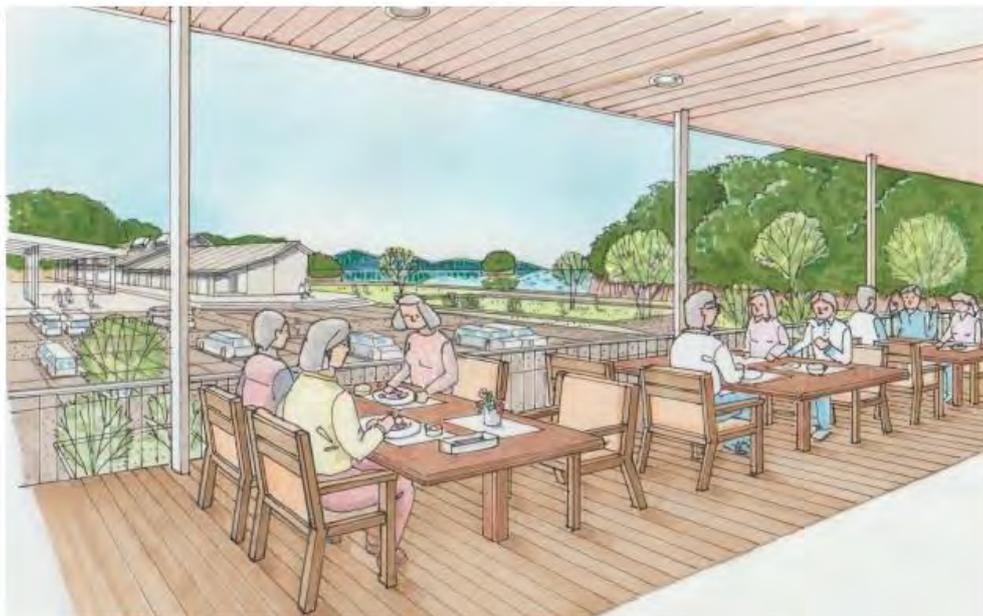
体験・滞在ゾーンの平面図及び整備イメージ
